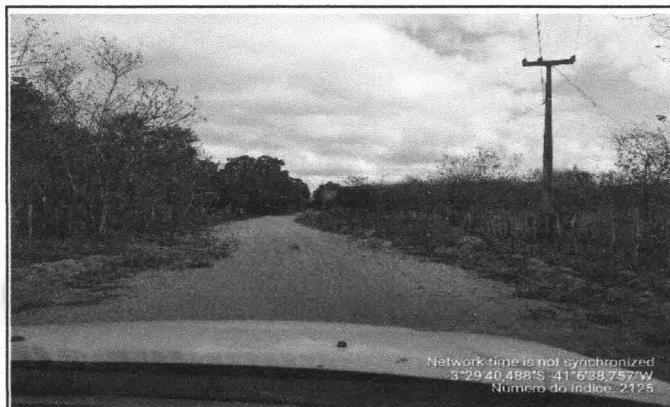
LOCAL DA CONSTRUÇÃO - BUEIRO TRÍPLA TUBULAR
